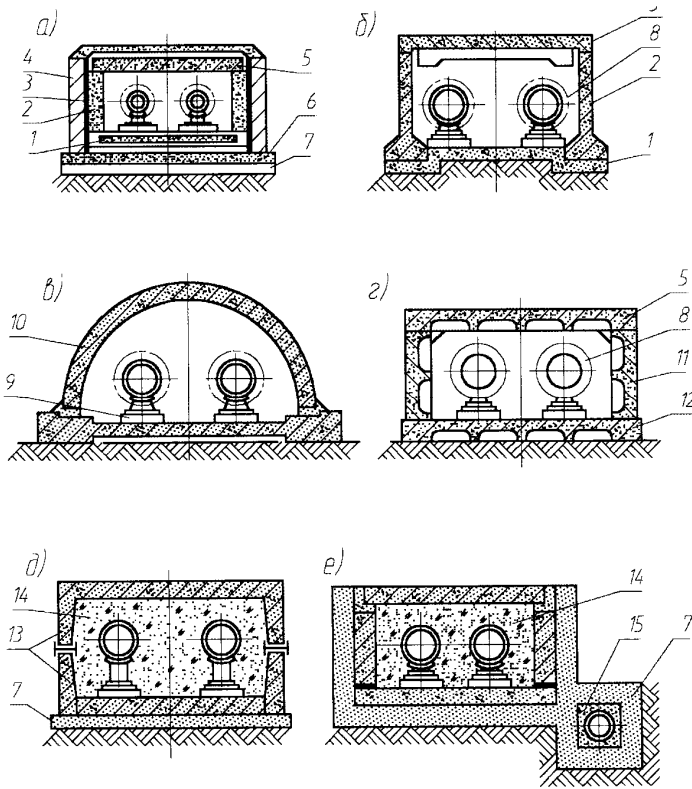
Непроходные каналы: *а* – сборный с клеечной гидроизоляцией; *б* – сборный из железобетонных плит; *в* – сводчатый с опорной рамой; *г* – сборный из вибропрокатных плит; *д* – из лотковых элементов; *е* – сборный с дренажем; 1 – железобетонное основание; 2 – стеновой блок; 3 – гидроизоляция; 4 – кирпичная стена; 5 – блок перекрытия; 6 – бетонная подготовка; 7 – песчаная подготовка; 8 – навесная теплоизоляция; 9 – подушка; 10 – железобетонный свод; 11 – рамы из вибропрокатных плит; 12 – плита днища; 13 – железобетонный лоток; 14 – засыпная изоляция; 15 – дренажная труба
